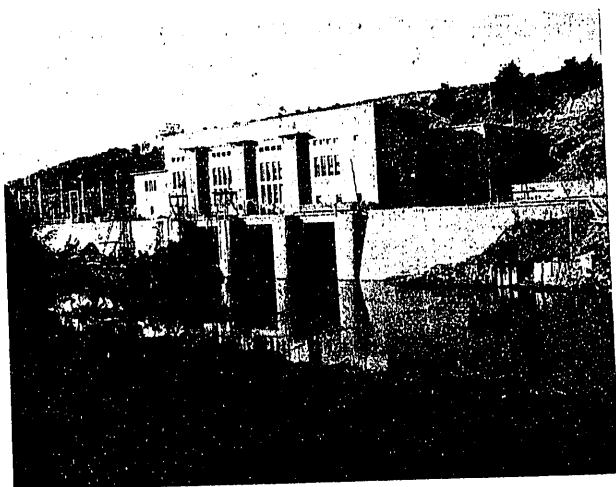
Vista exterior de la Central. En segundo término, la sala de válvulas y la cámara de equilibrio.
